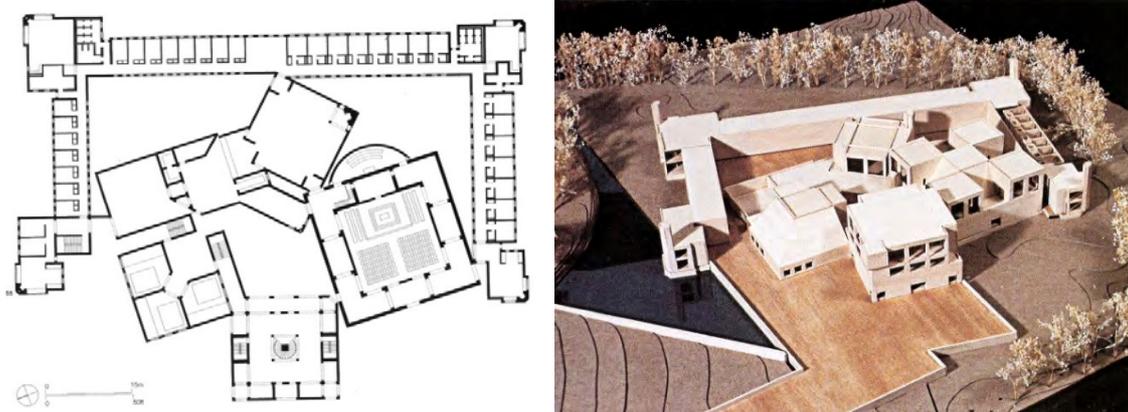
e 105 | Planta e maquete Dominican Motherhouse [McCARTER]
